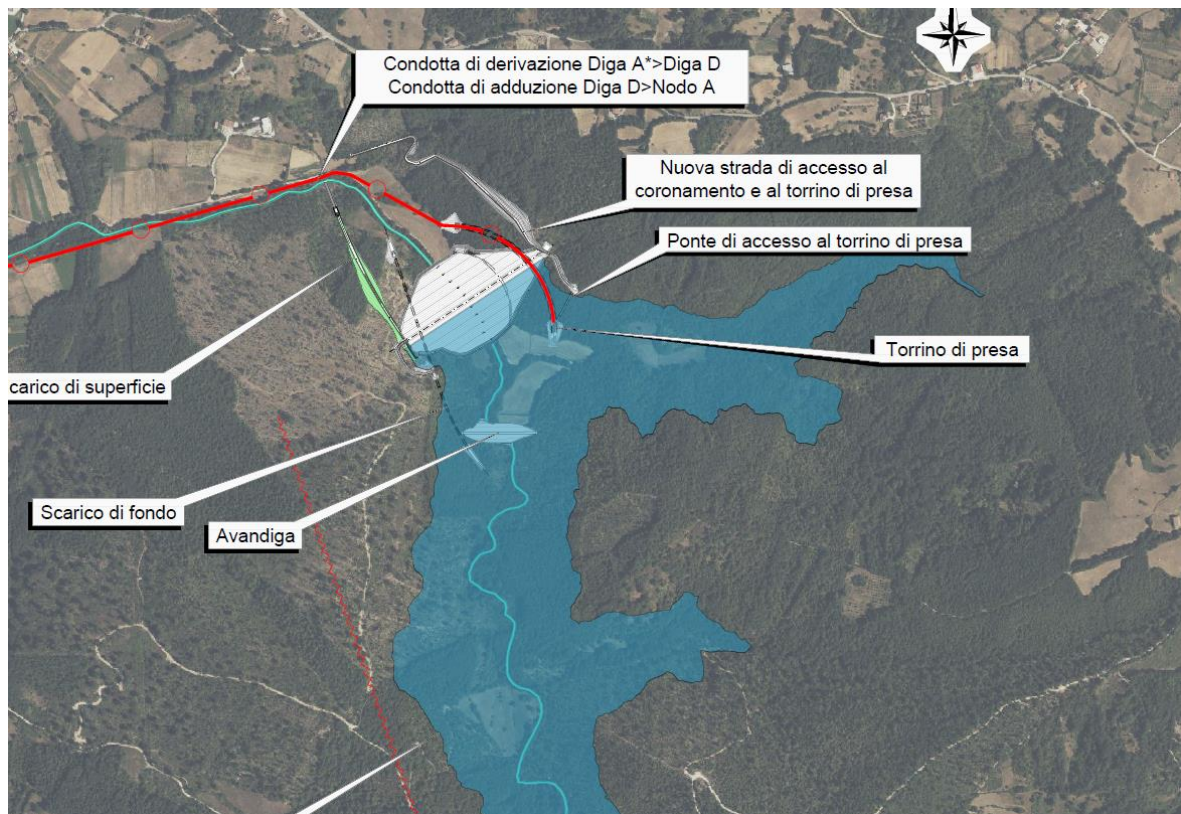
Alternativa 2 (A1*+D), planimetria generale di progetto sito D (fonte DOCFAP, 2024)
